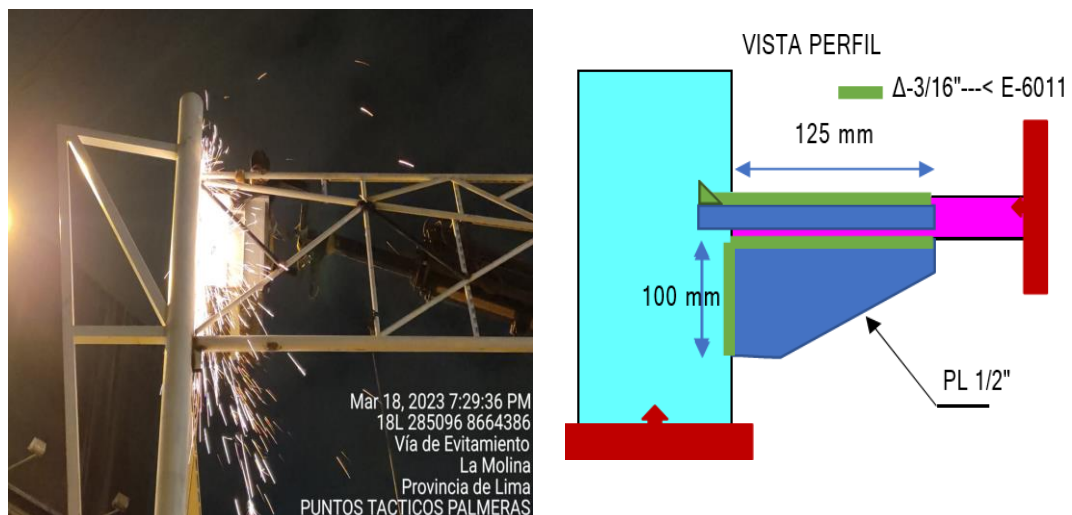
Cordón de soldadura de bridas y cartelas. Fuente: Elaboración propia.
